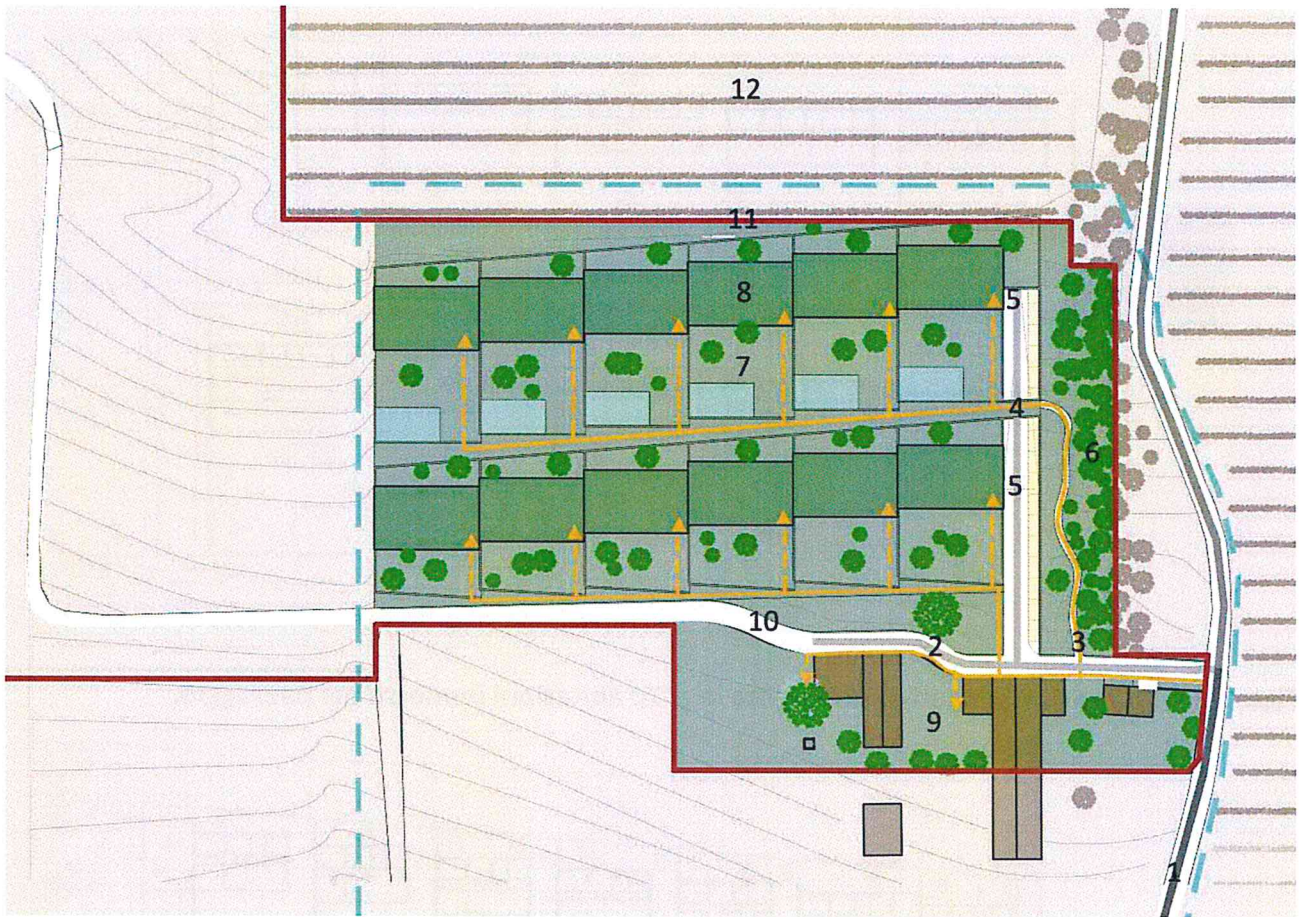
Ipotesi dell'intervento in progetto – legenda:
